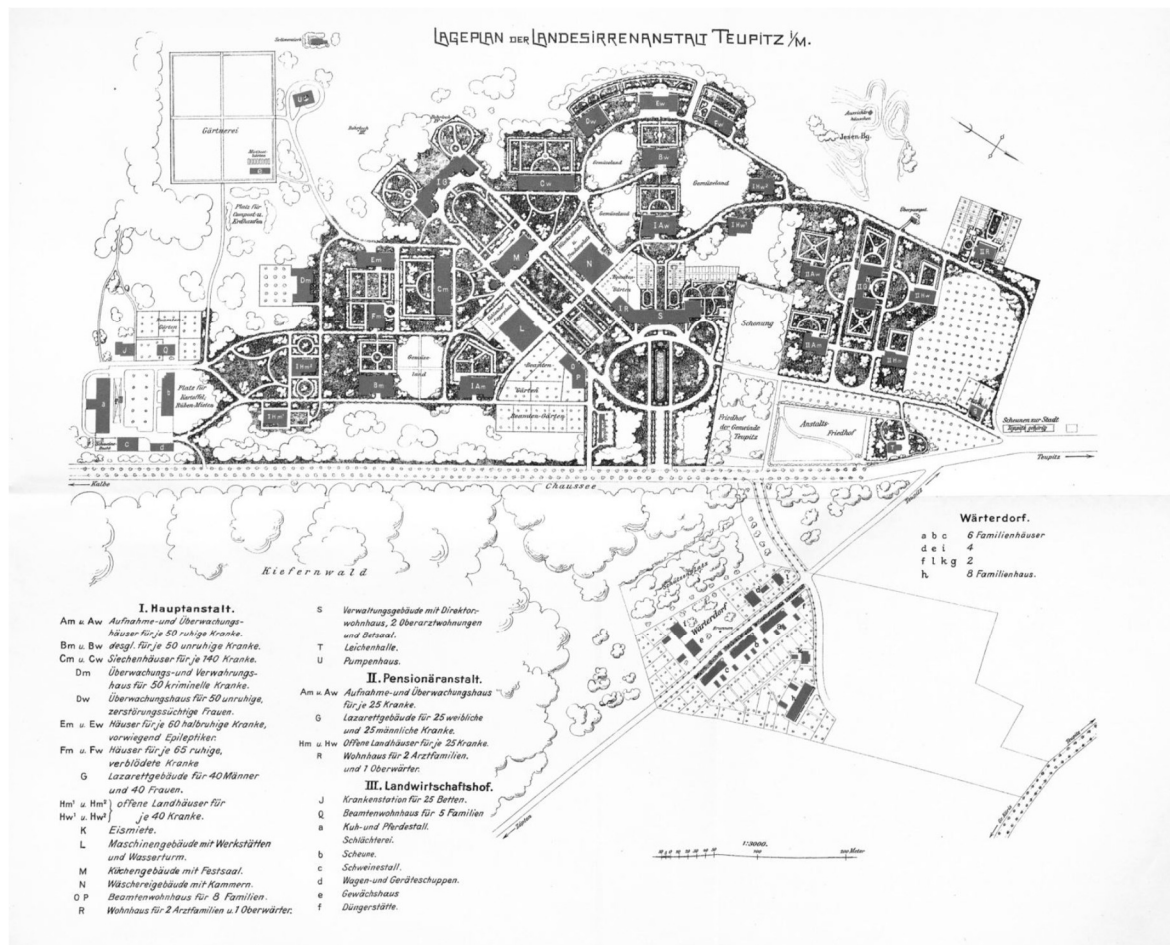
Lageplan der Landesirrenanstalt Teupitz 1907
